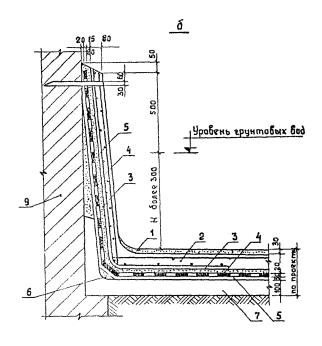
Конструкция гидроизоляции по грунту и существующему бетонному полу при уровне грунтовых вод (Н) более 500 мм и для помещений высотой менее 1,7 м при Н более 300 мм
